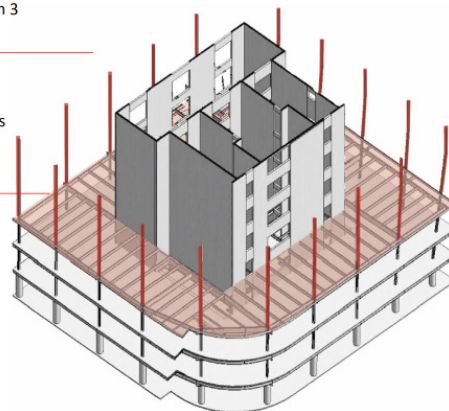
São Paulo Corporate Towers | Sequência Típica de Execução
